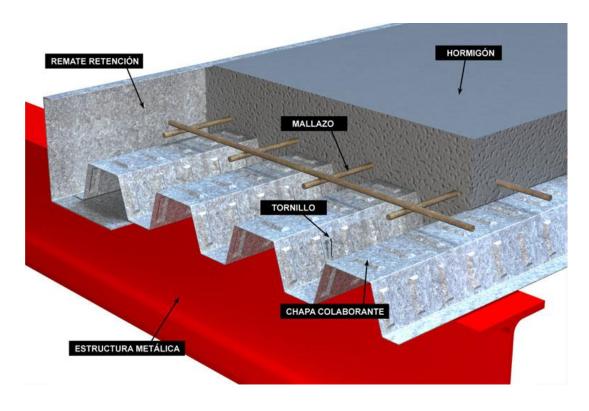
Sistema constructivo Steel Deck. Fuente: Arquitectura + Acero
